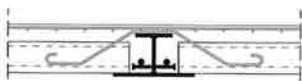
La tour Swisscom à Winterthur comporte des planchers «slim floor» avec poutres intégrées en acier et poteaux mixtes acier-béton.
